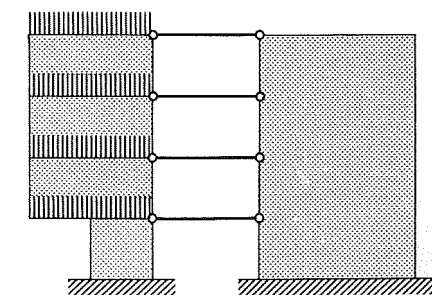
Konstruktionsmodel for bygning med åben underetage. Længdeafstivning er ikke vist. For lodret last er dækkene stadig simpelt understøttede plader, men de mellemste tværvægge må betragtes som skiver, der fører lasten ud til søjlerne i stueetagen. For vandret last bør alle vægge og dæk betragtes som skiver.
